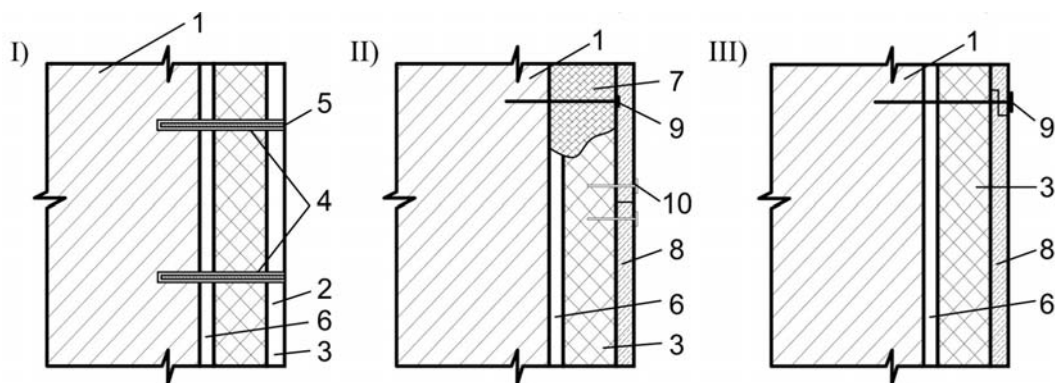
Три варианта конструкций утепления наружных стен крупнопанельных зданий:
